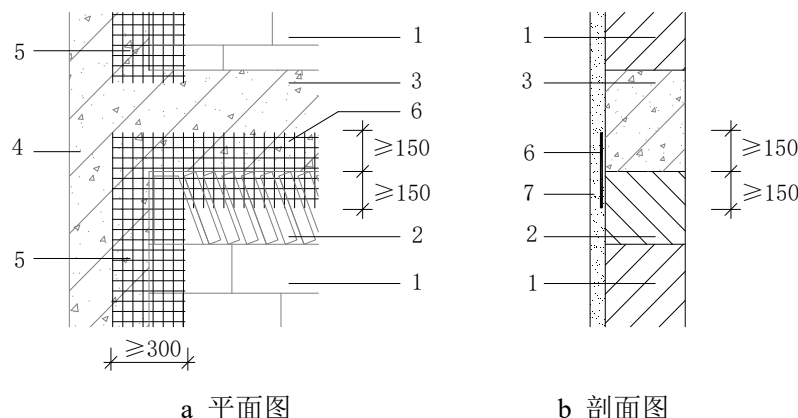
混凝土梁、柱与砌体接缝防水抗裂增强处理
